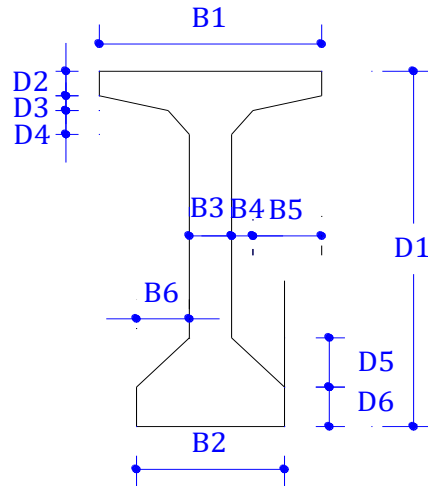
Predimensionamiento de viga preesforzada AASHTO I.
